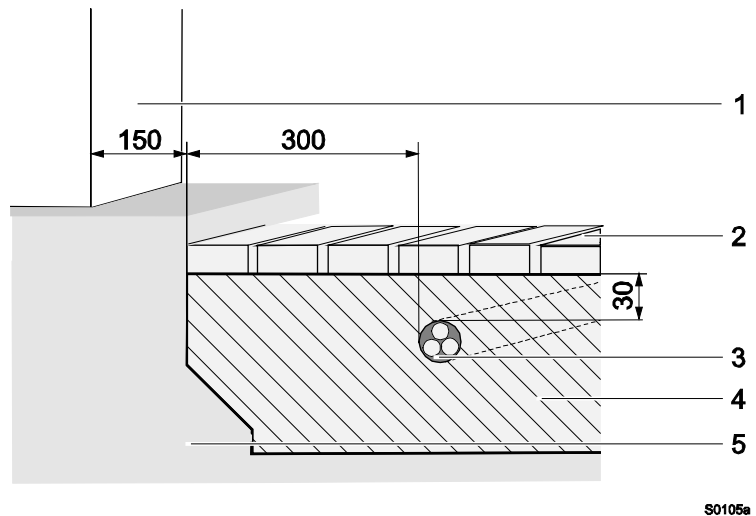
Placera induktionsslingor i bitumen, asfalt eller betong (mått i mm)
